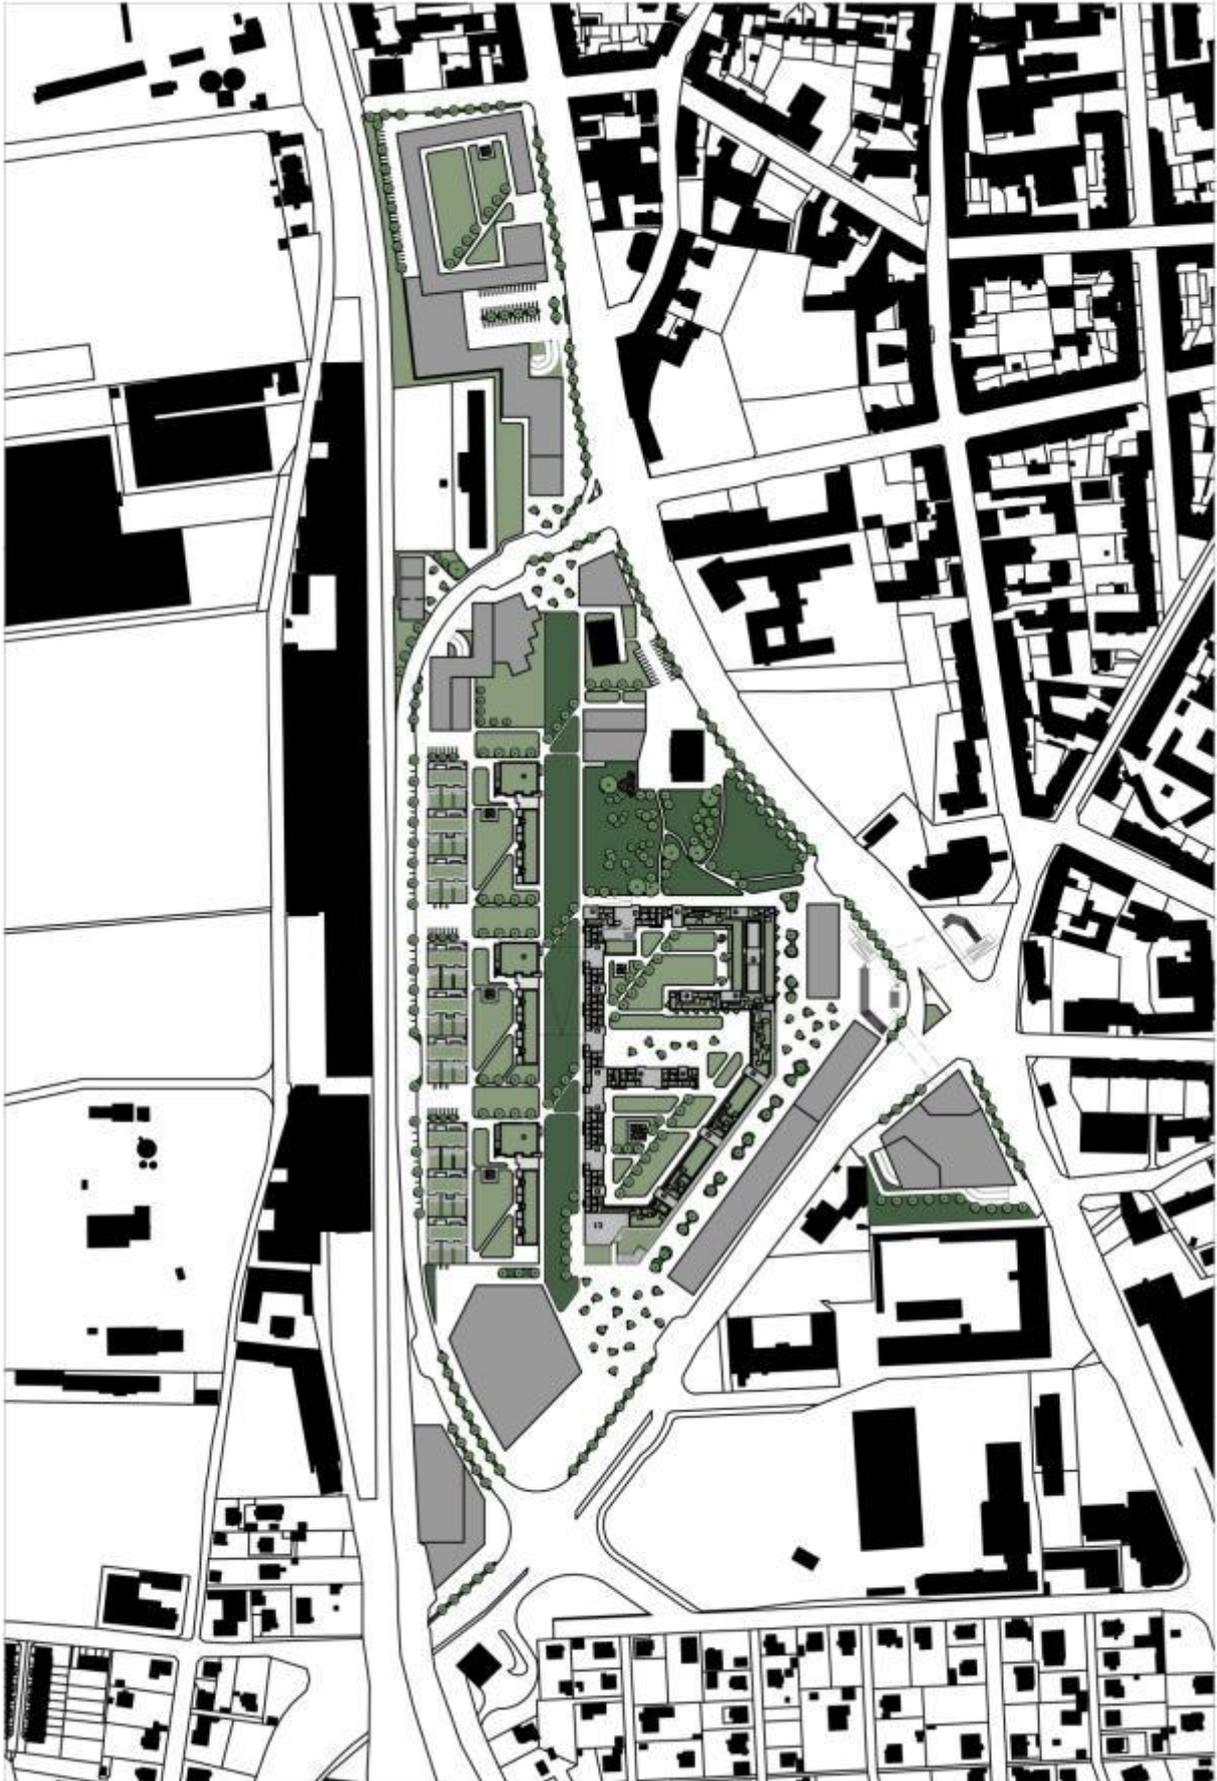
Lageplan bzw. Draufsicht auf das Planungsgebiet
